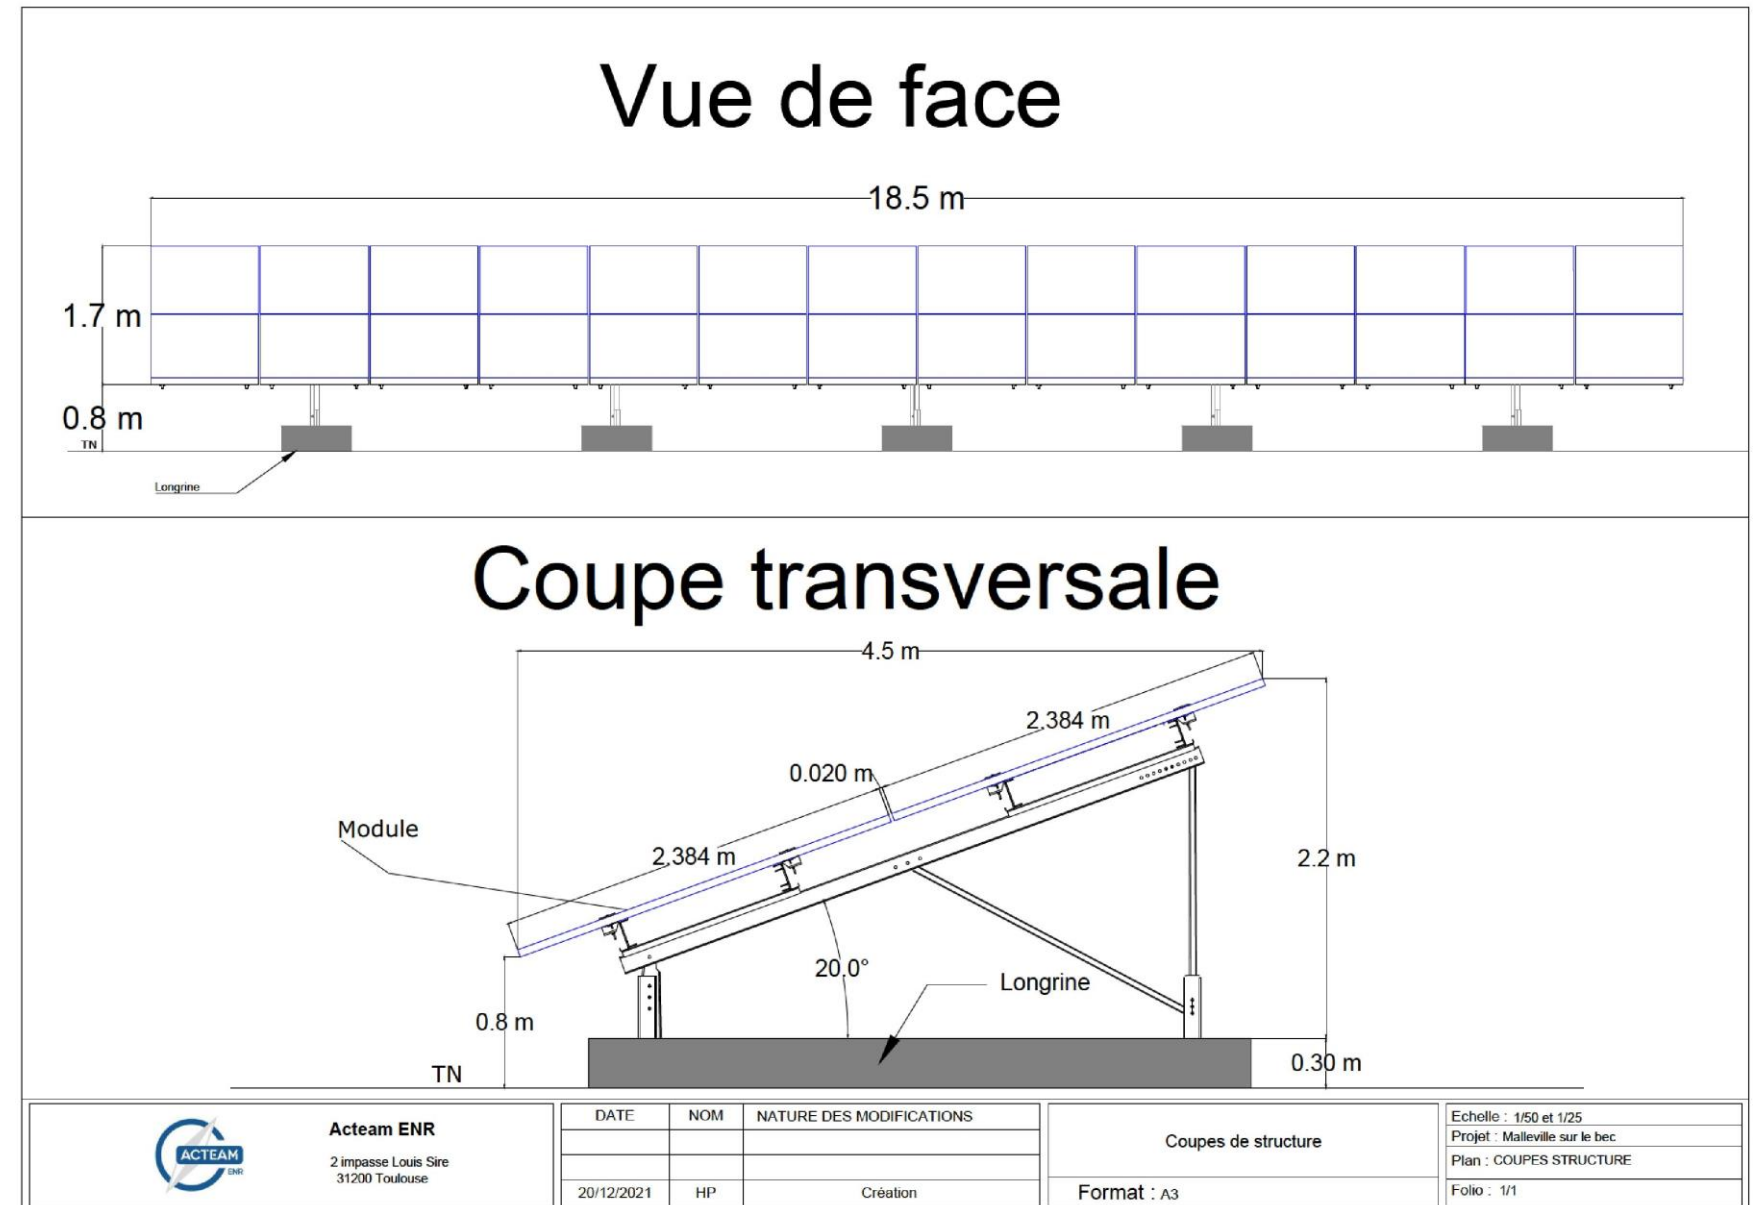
Plan de façade d'une table photovoltaïque (Source : ACTEAM)
